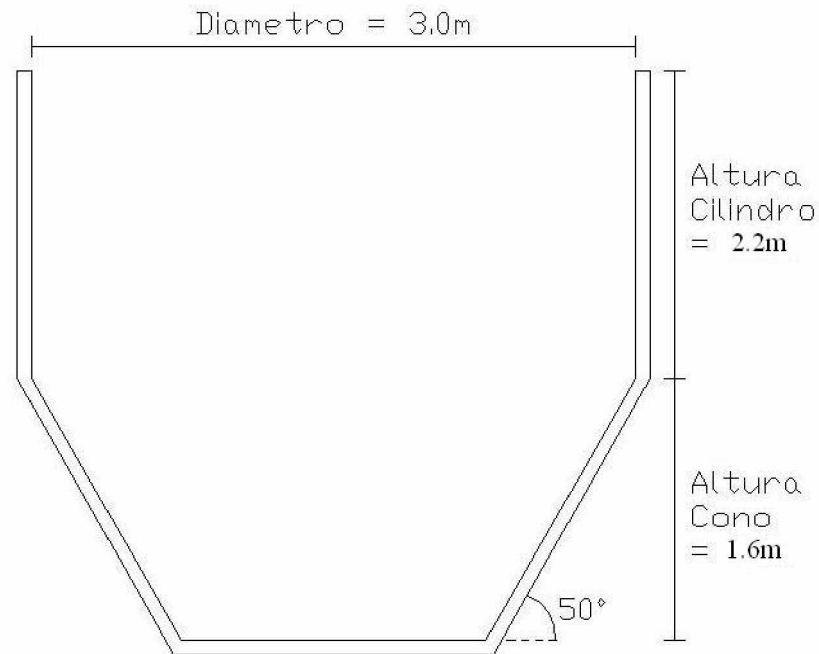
Sección del sedimentador primario de la Planta N°2
